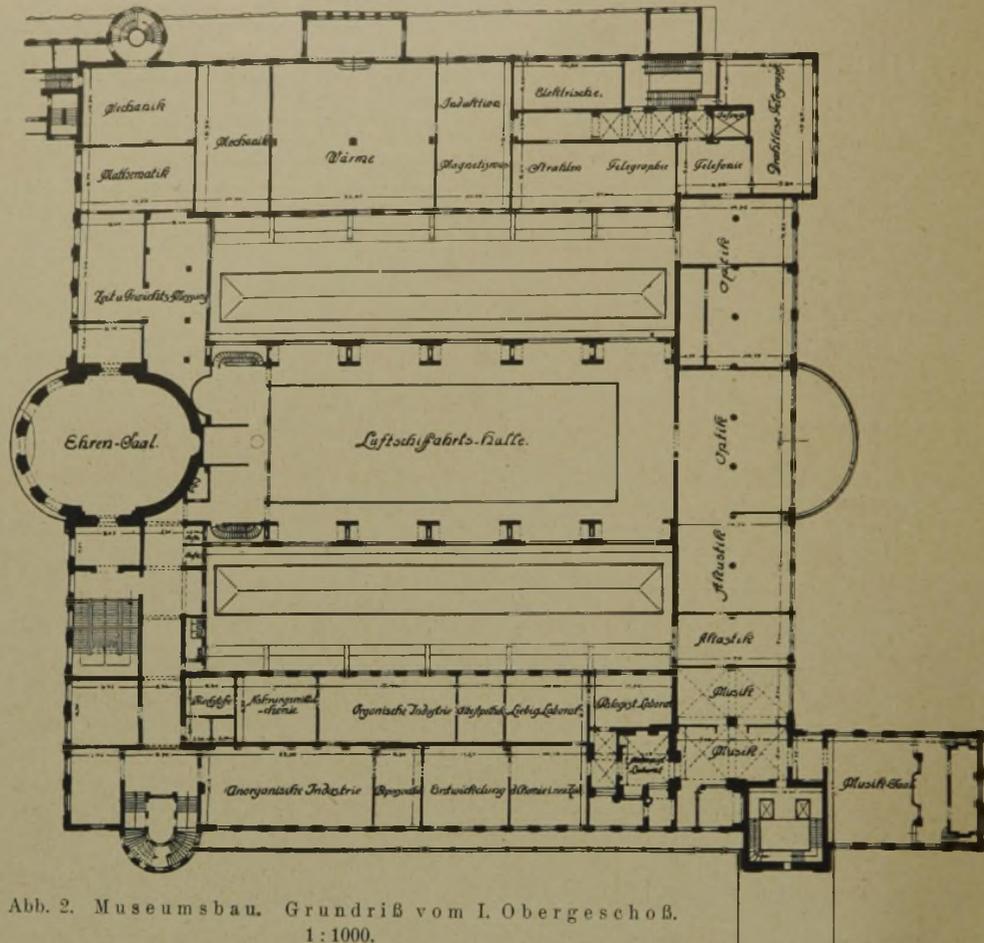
Museumsbau. Grundriß vom I. Obergeschoß.
